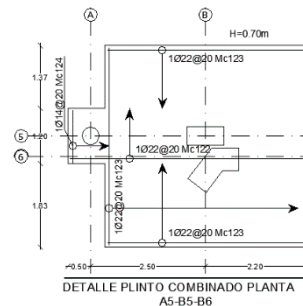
Dimensiones y Armado de Cimentación. Fuente: Planta Física-PUCE.
